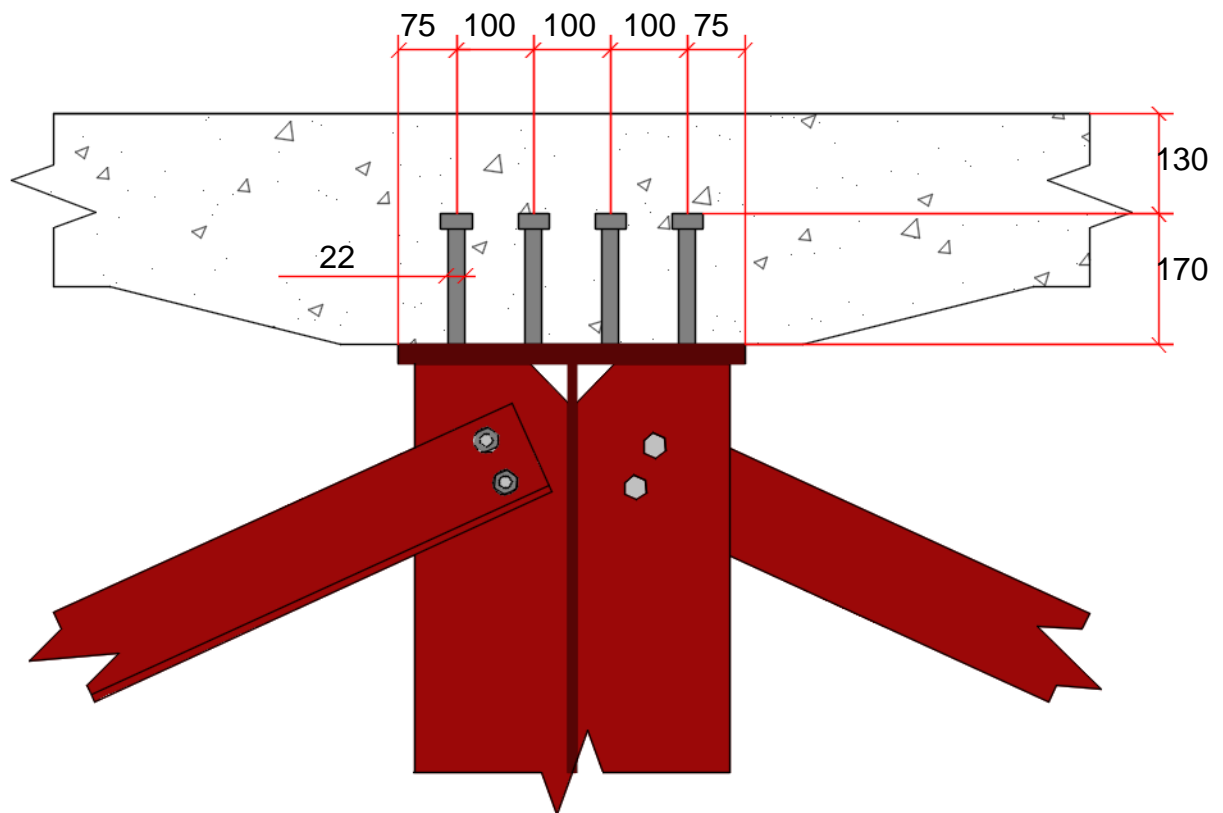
Vista em corte dos conectores de cisalhamento. Unidades em mm.
